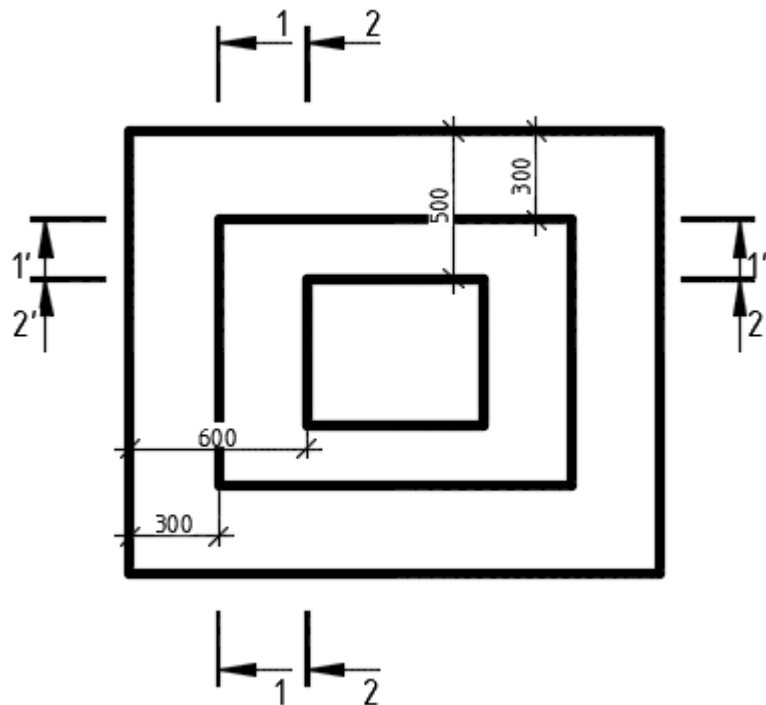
Схема к расчету плиты фундамента на изгиб
